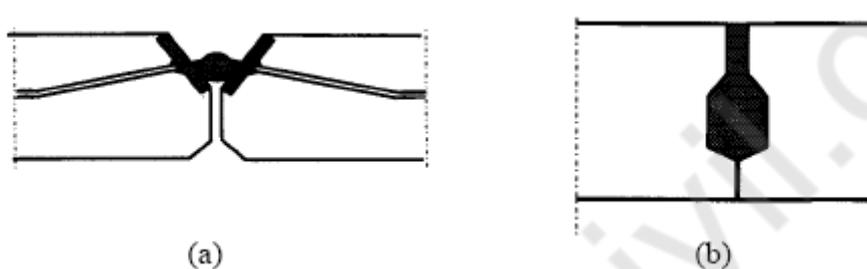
Assemblages soudés et joints remplis entre deux éléments de plancher TT
